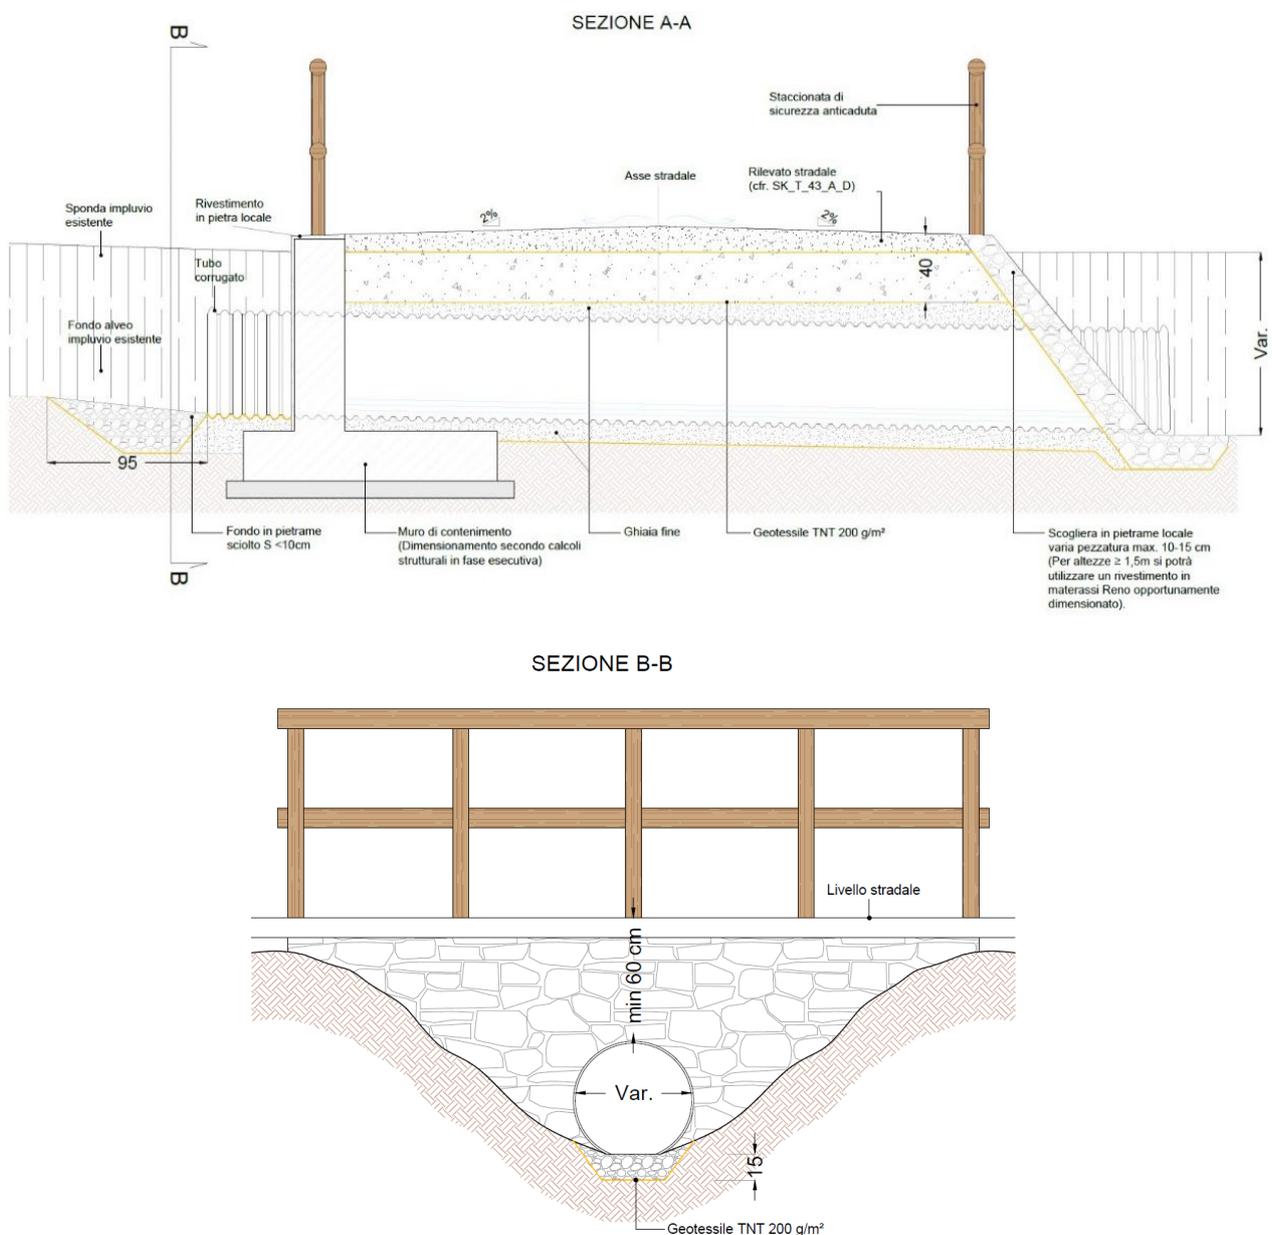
Sezioni tipo dell'attraversamento stradale di un impluvio – tutte le misure in cm
